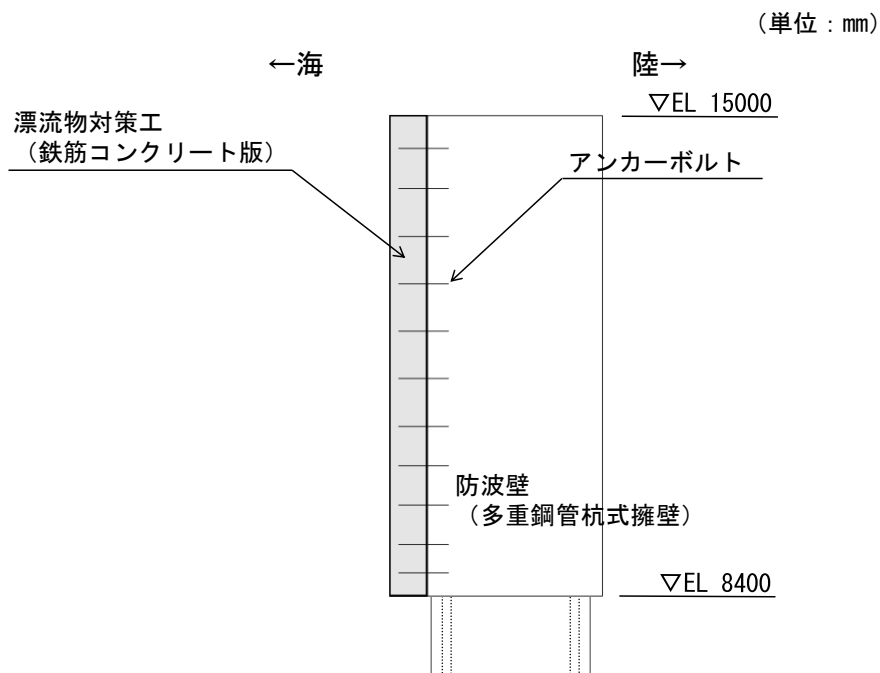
漂流物対策工（鉄筋コンクリート版）の構成部位
